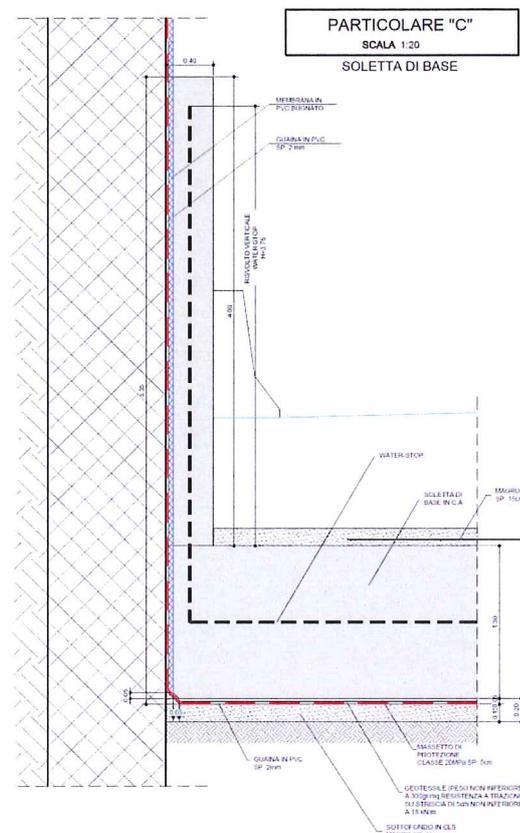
Particolare impermeabilizzazione solettone di fondo (sezione fra diaframmi)
